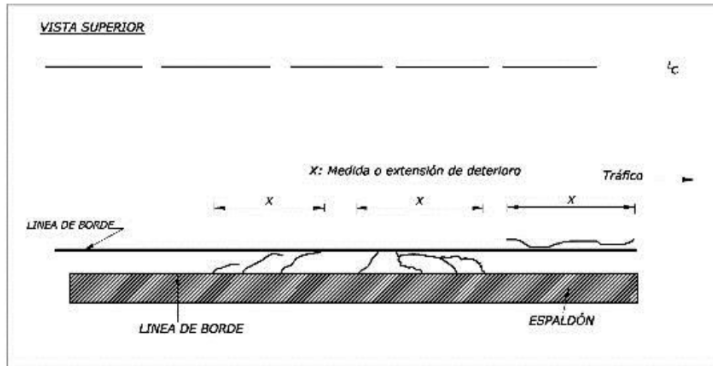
Esquema Grietas de Borde– Pavimento Flexible
